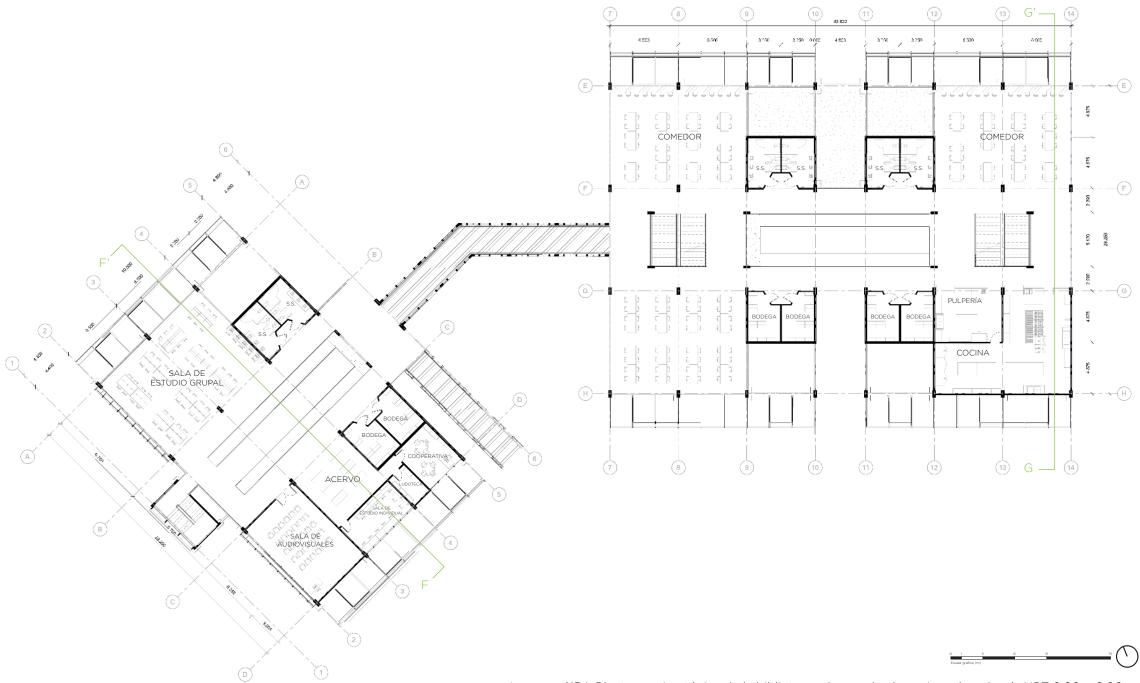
Planta arquitectónica de la biblioteca, el comedor, la cocina y la pulpería NPT 0,00 + 0,00 m
